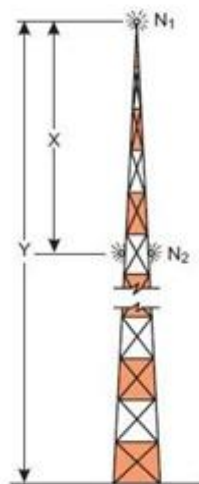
Shembuj të shënjimit dhe ndriçimit të strukturave të larta
